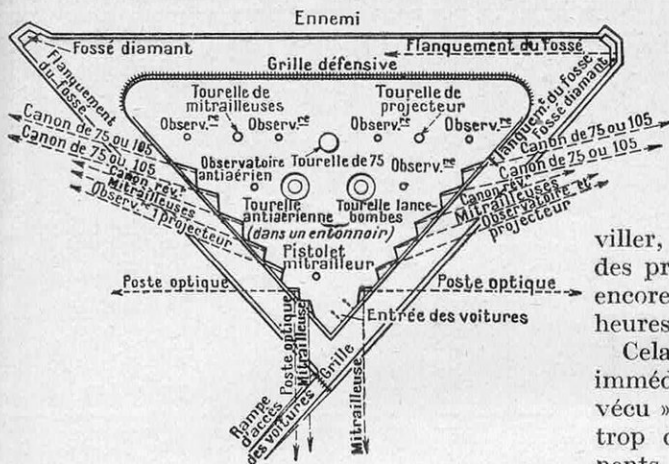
PLAN D'UN FORT FRANÇAIS MODERNE
